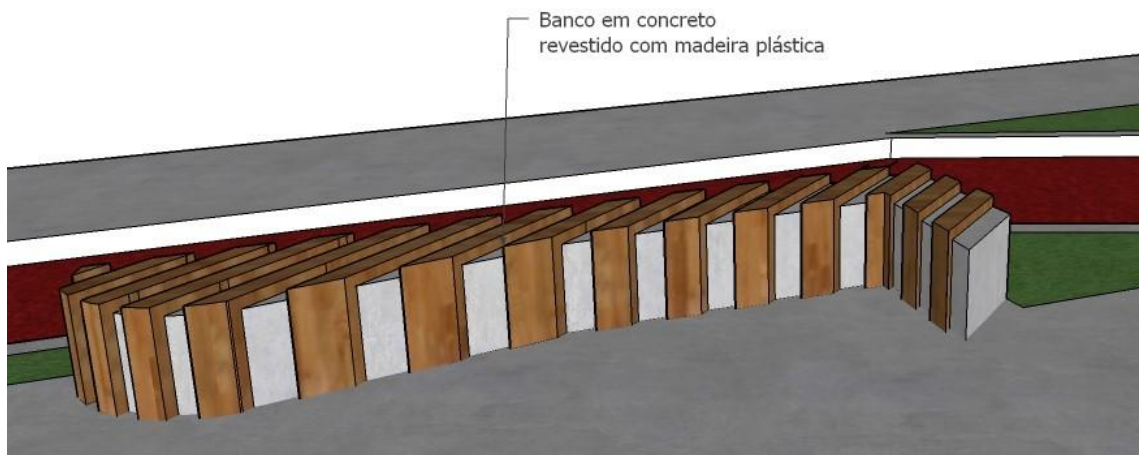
Modelo de Banco de Concreto revestido em madeira plástica
